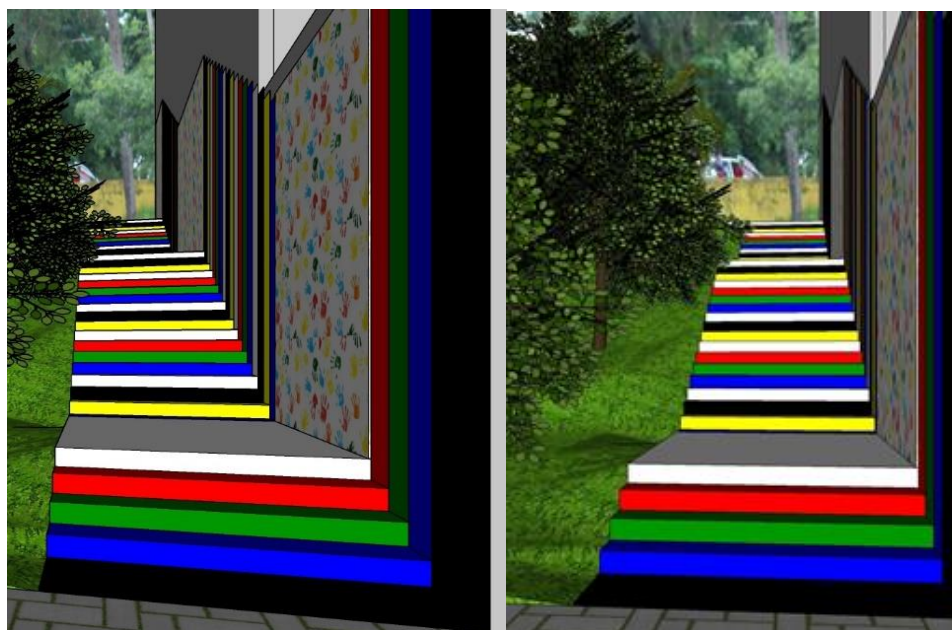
e 7: Detalhes da proposta de intervenção – acervo das autoras
